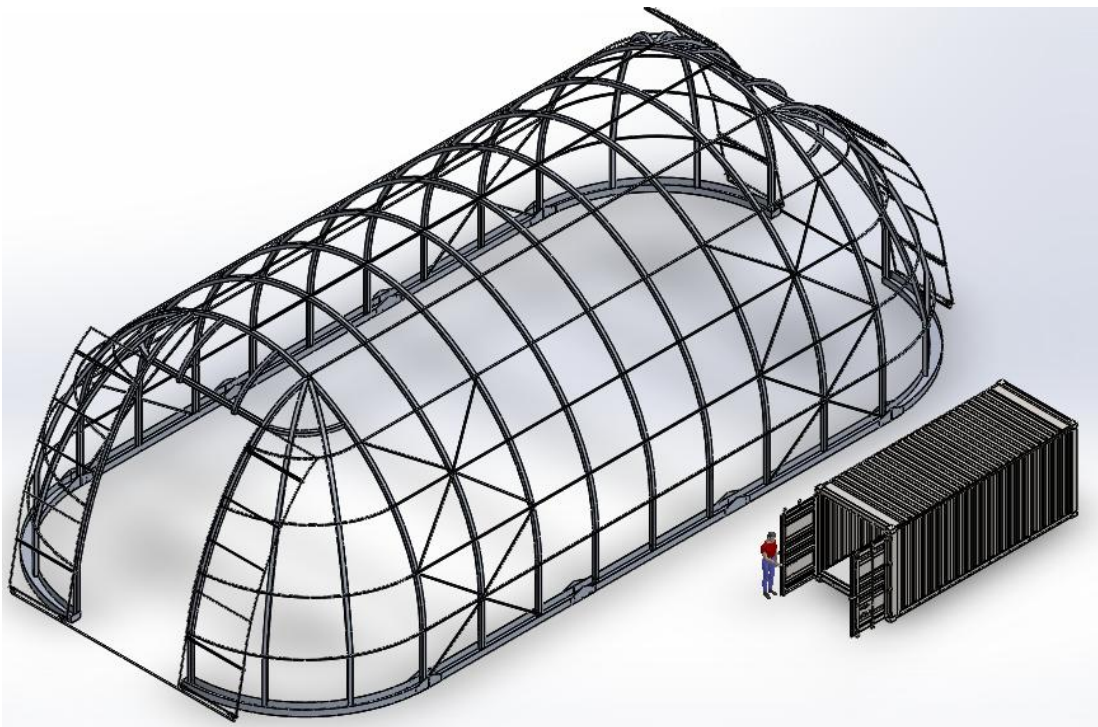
Assemblaggio finale del capannone con elementi comparatori
